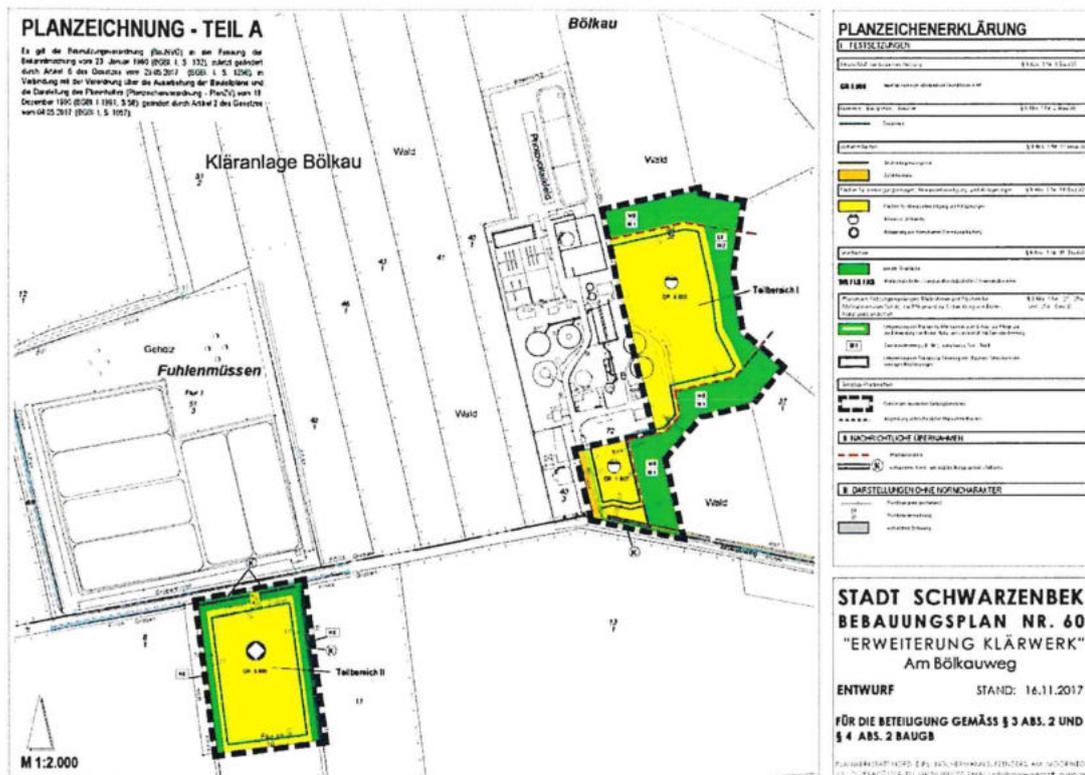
Plangeltungsbereich zur Erweiterung der Kläranlage Bölkau – B-Plan Nr. 60.
